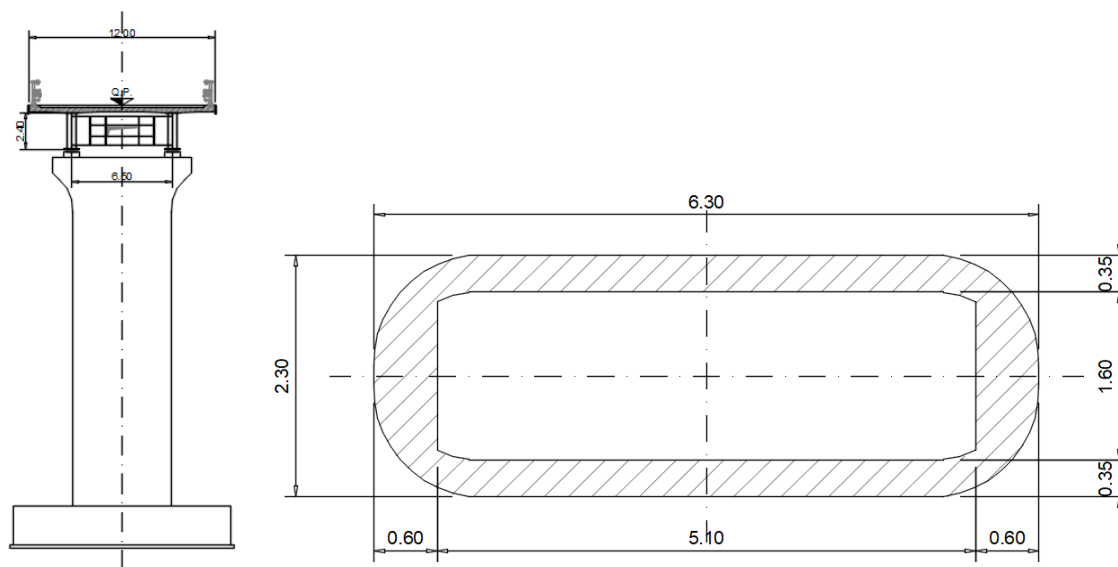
Mezzanelle – Carpenteria e Sezione tipo pile
